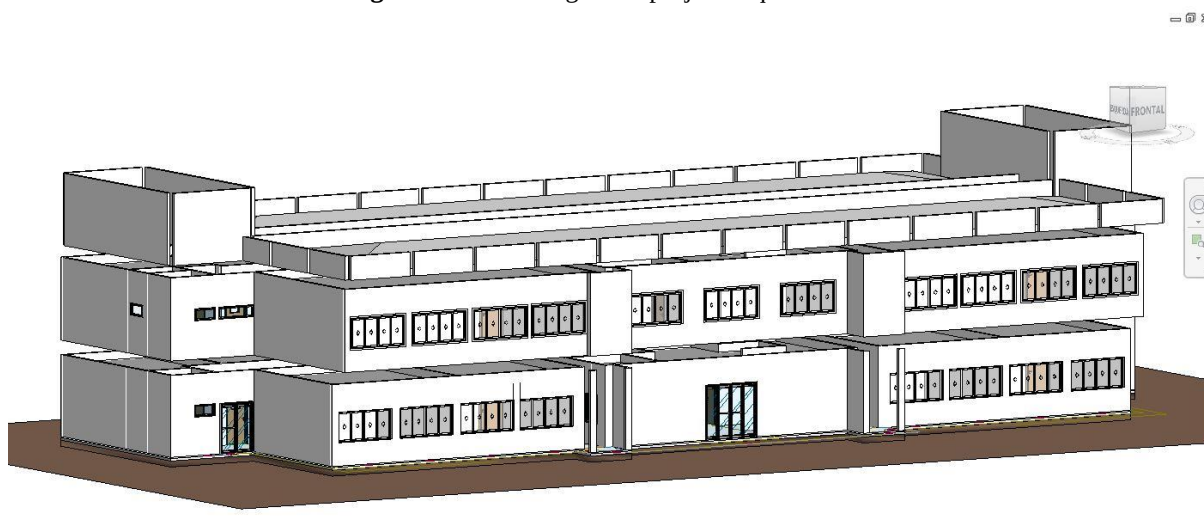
Modelagem do projeto de estrutura de concreto armado.
